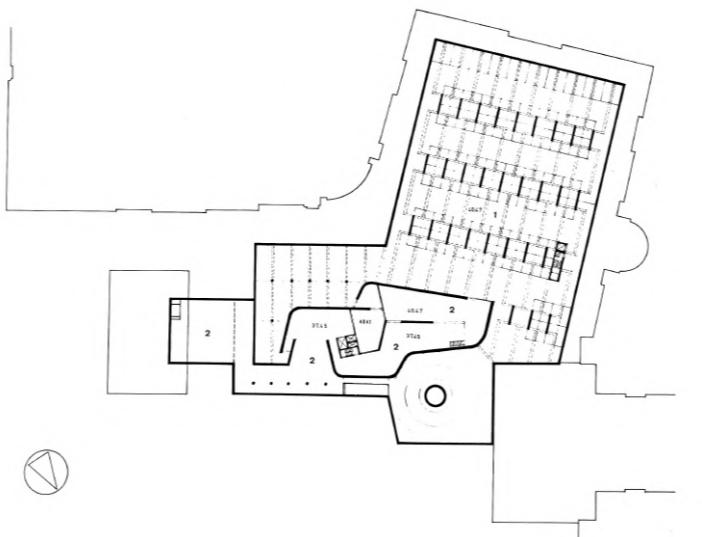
Plan d'un niveau de parking, avant-projet du musée signal.
